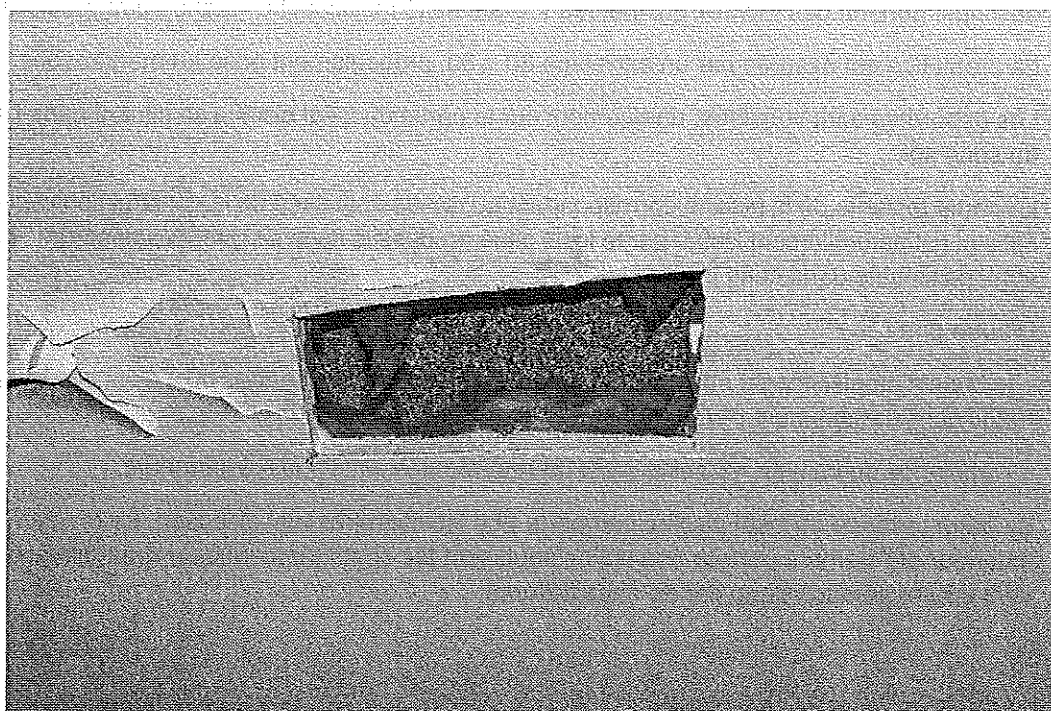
Sondage pratiqué dans le faux-plafond rapporté. © J. Putatti
